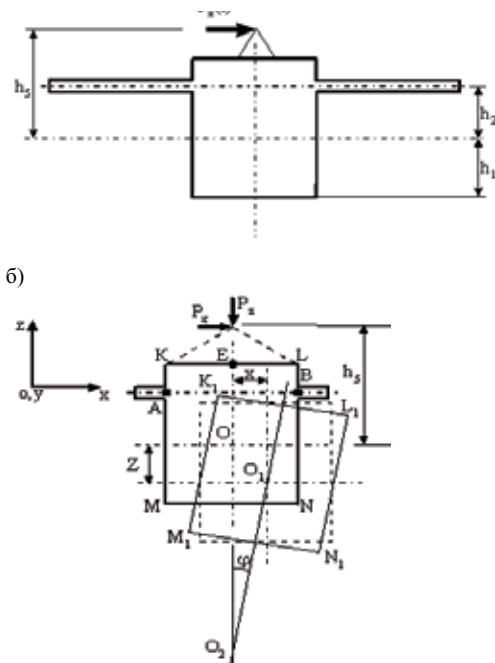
Расчетная схема горизонтально-вращательных перемещений массивно-плитного фундамента.
